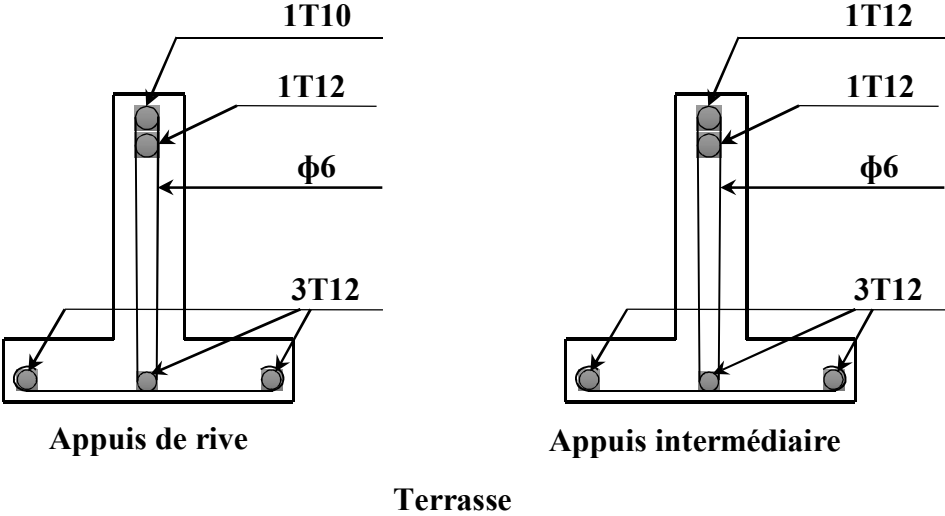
Dessin de ferrailage des poutrelles des terrasses
